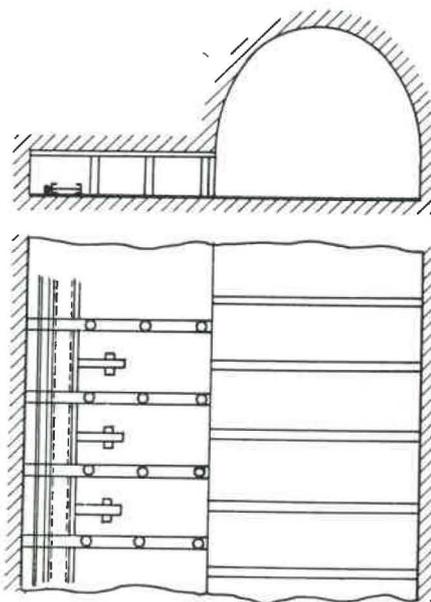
Démarrage de la taille à partir d'un montage cadré.
